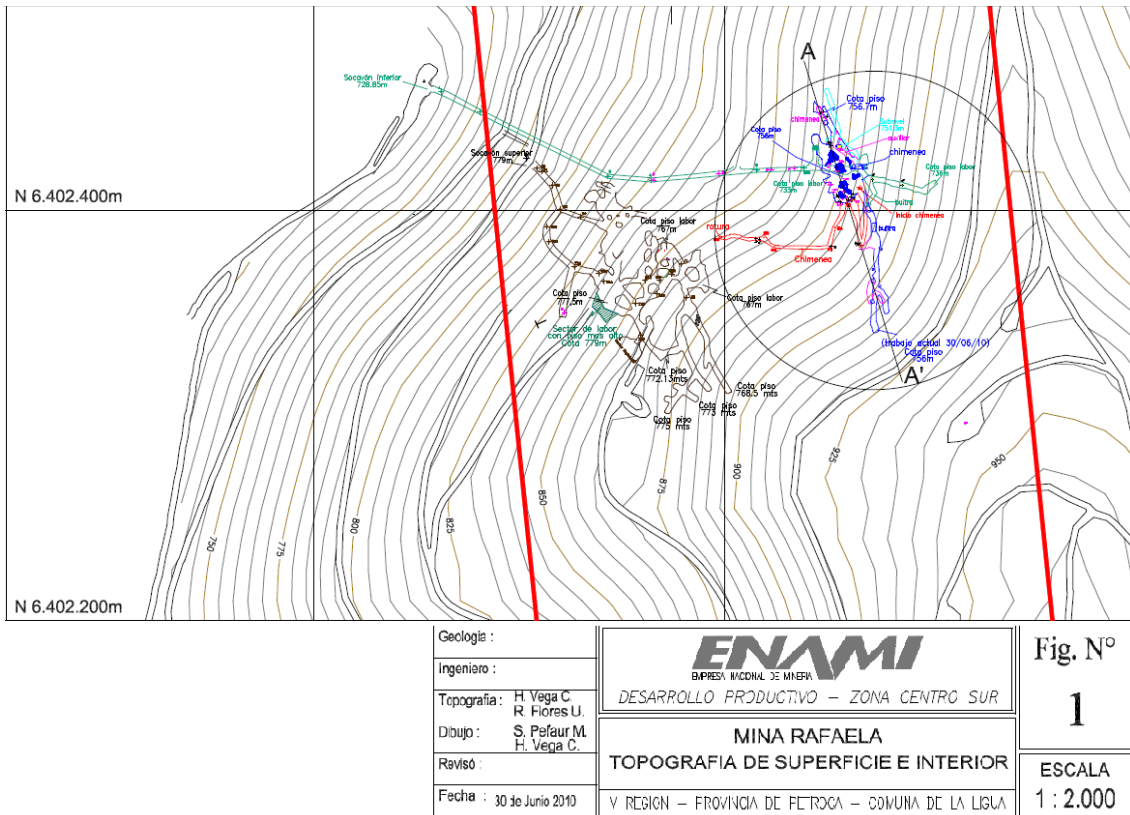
Vista en Planta sectores de estudio socavón 728-779
